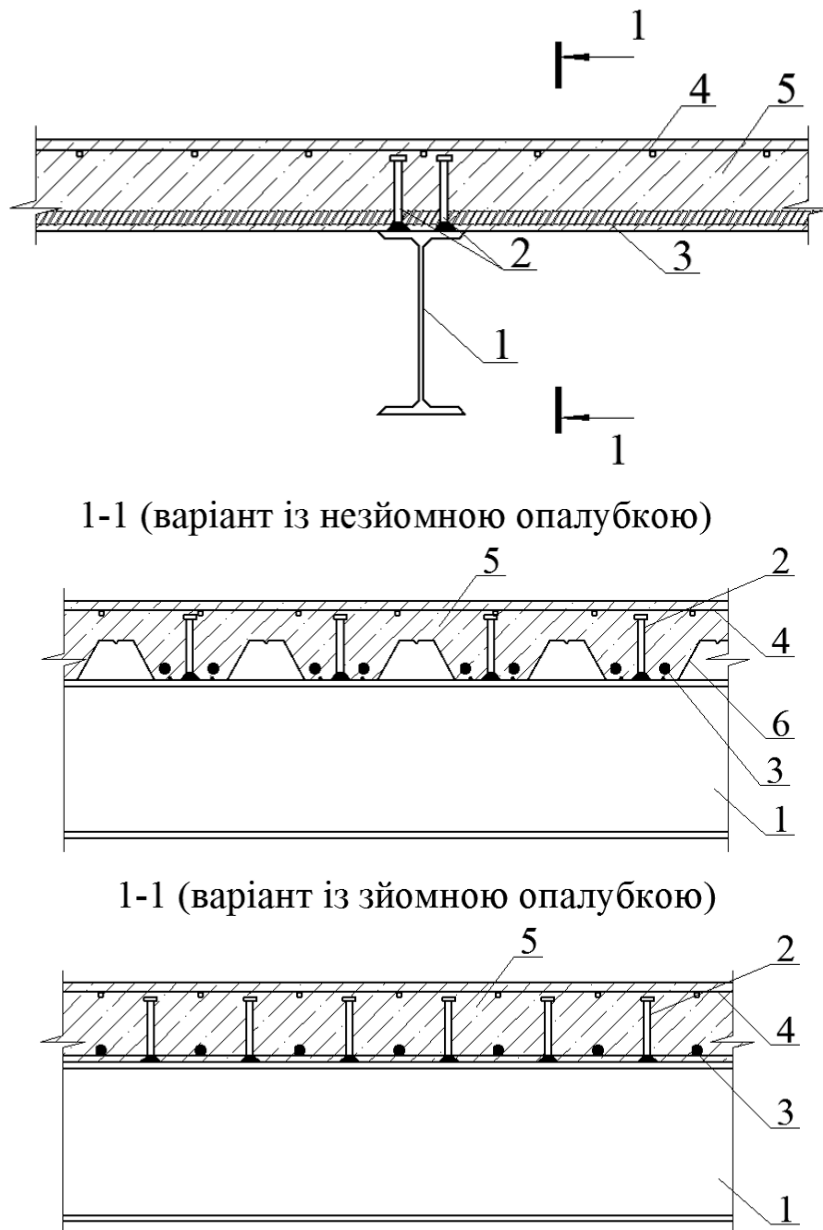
Залізобетонне перекриття по сталевих балках:
